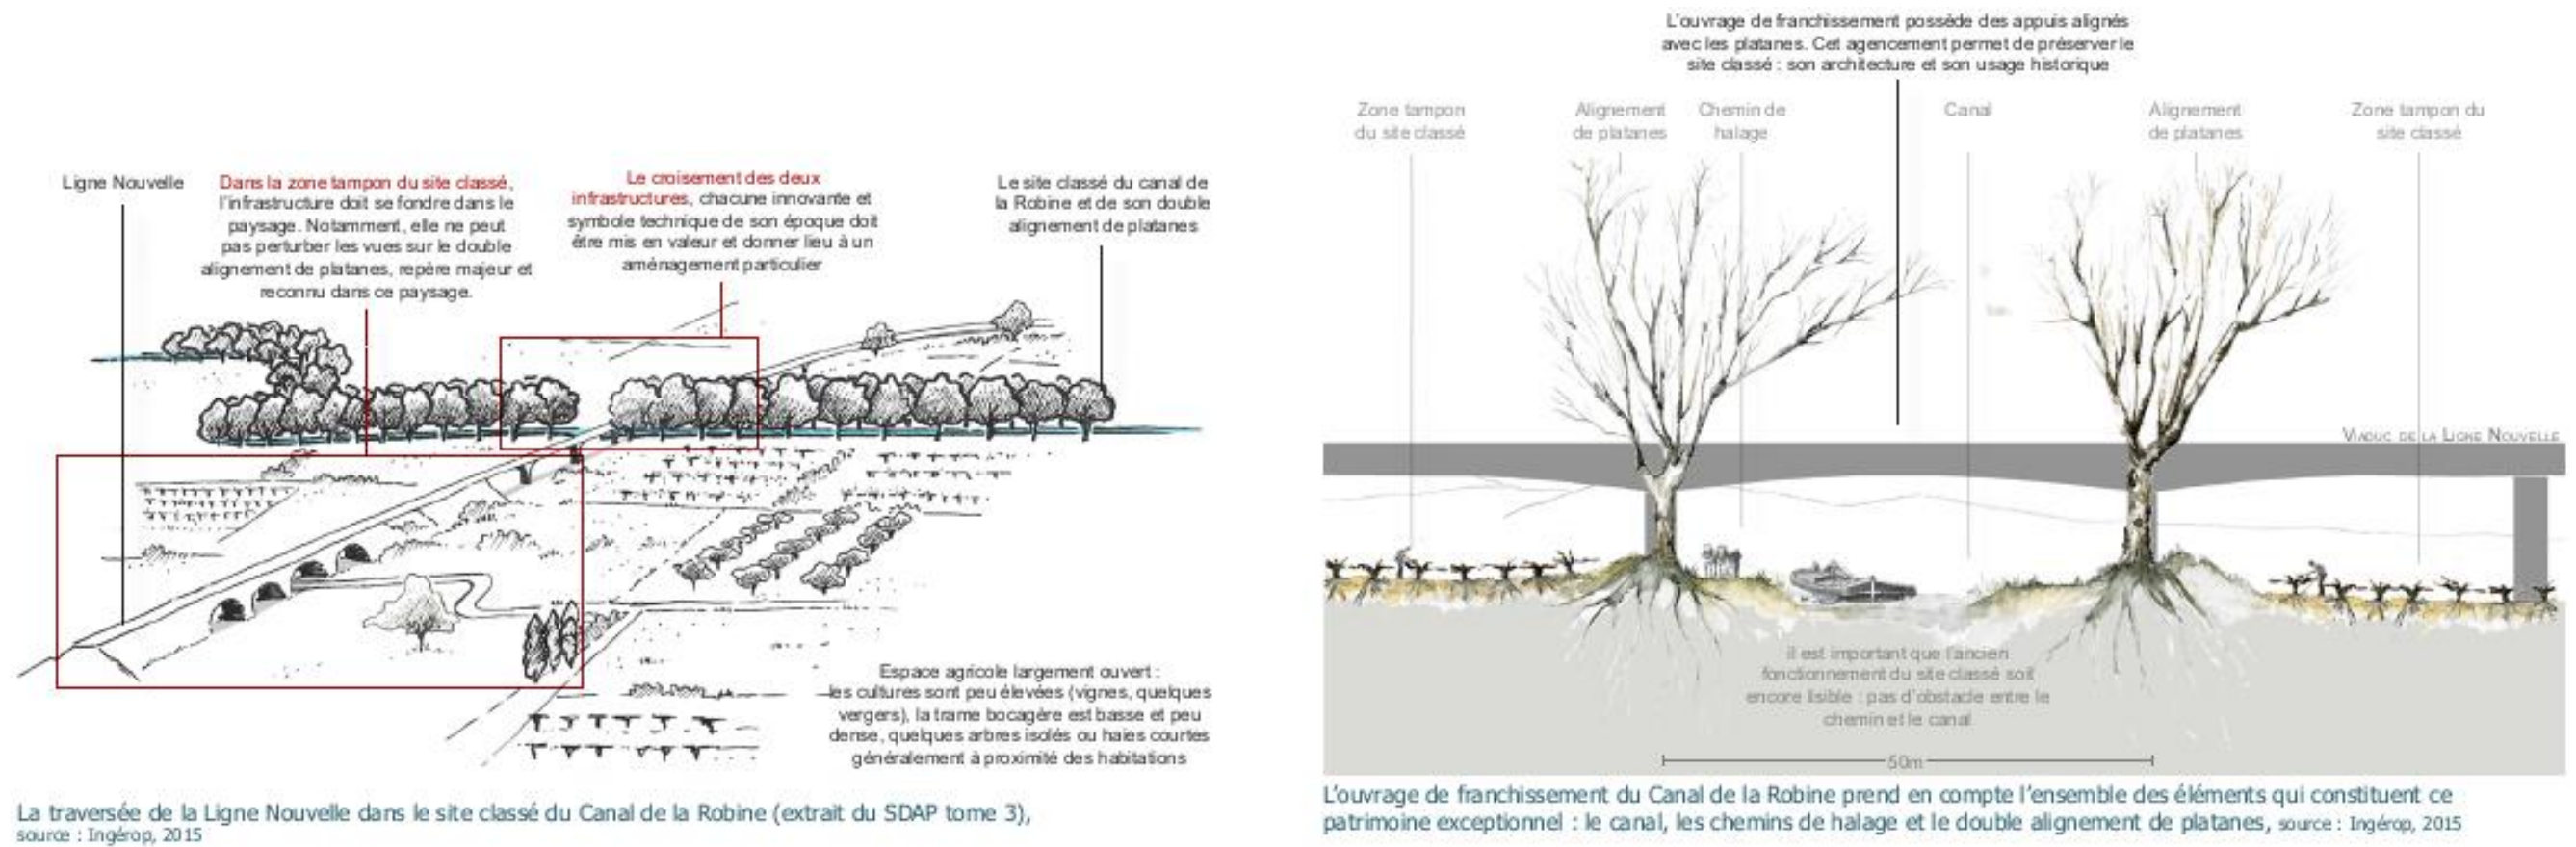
croquis de la traversée du site inscrit au droit du canal de la Robine (source : Ingerop, études préliminaires à approfondir en phase de conception ultérieure)
